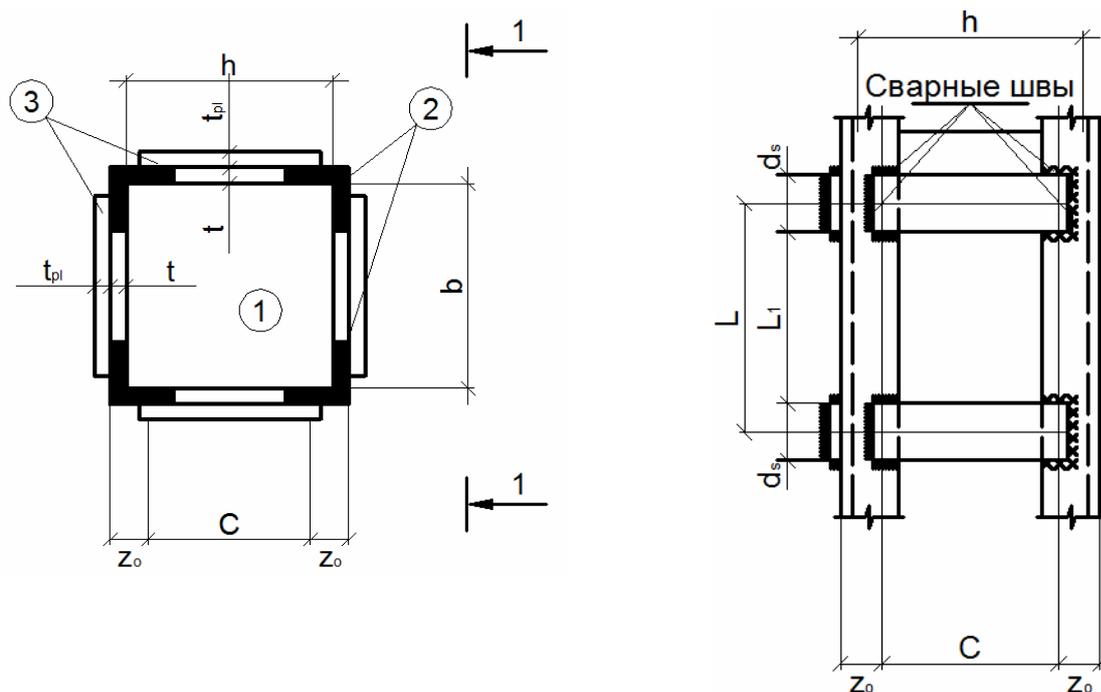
Расчетная схема усиления колонн металлической обоймой:
